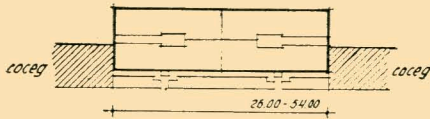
Забудова по вулиці між існуючими будинками. Всі входи до квартир з вулиці, з боку головного фасаду. Забудова передбачає відступ від червоної лінії на 4—5 м і може бути проведена в розриві від 26 м до 108 м.
